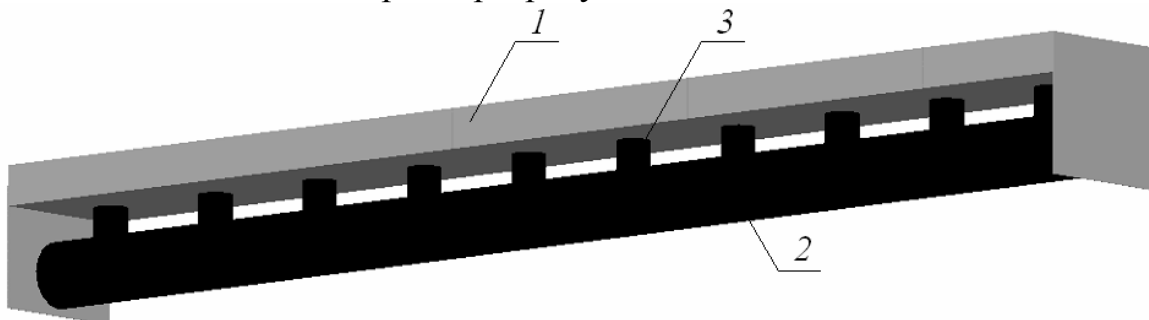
Сталезалізобетонна балка з армуванням трубою
